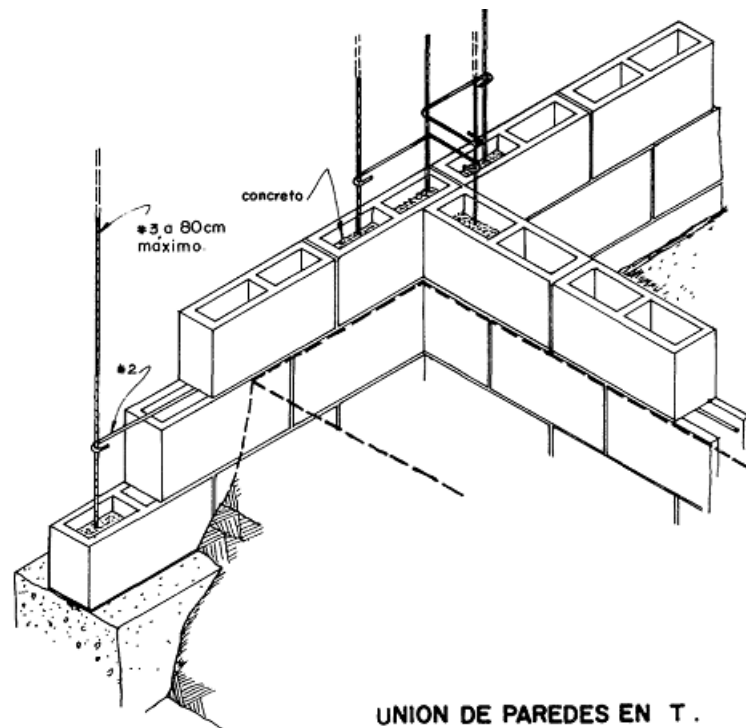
Detalle del suple de refuerzo horizontal en el encuentro de muros (Moas, 1993)
